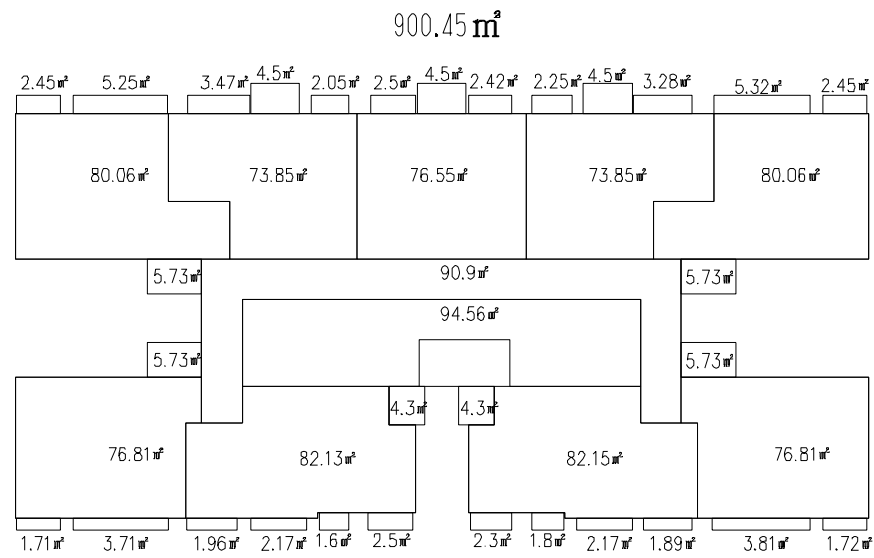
八~十三、十五~十七、二十~二十七層平面圖(1/400)
